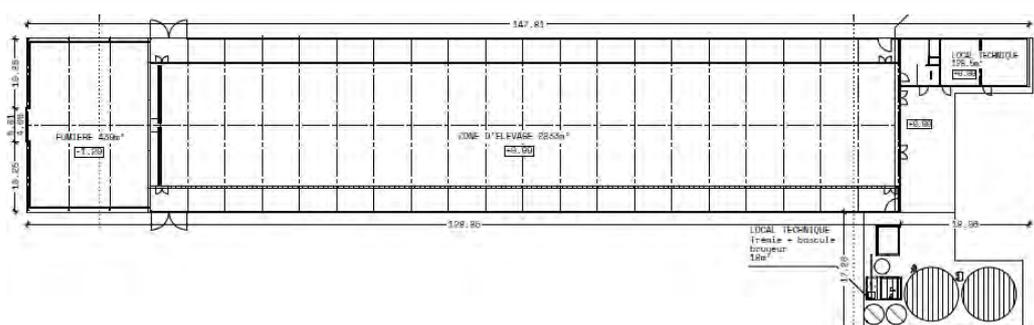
Plan interne du bâtiment V2 (BONNET et BAUDET Architecte)
